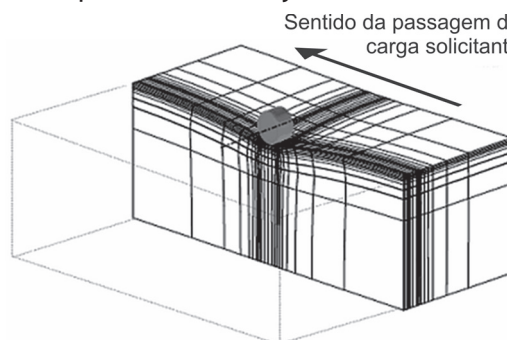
Desenho esquemático da aplicação do carregamento na malha da estrutura do pavimento (HECK, 2001).
